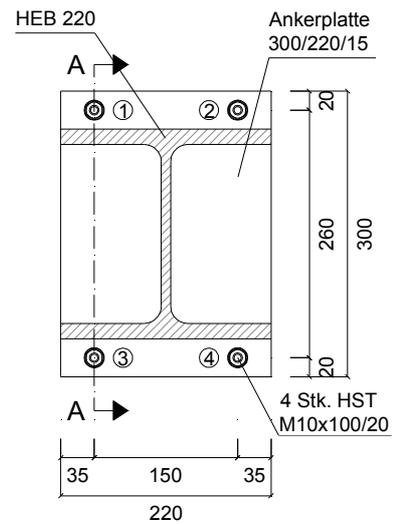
Anschlussdetail T1 Dübel (Maße in mm)
